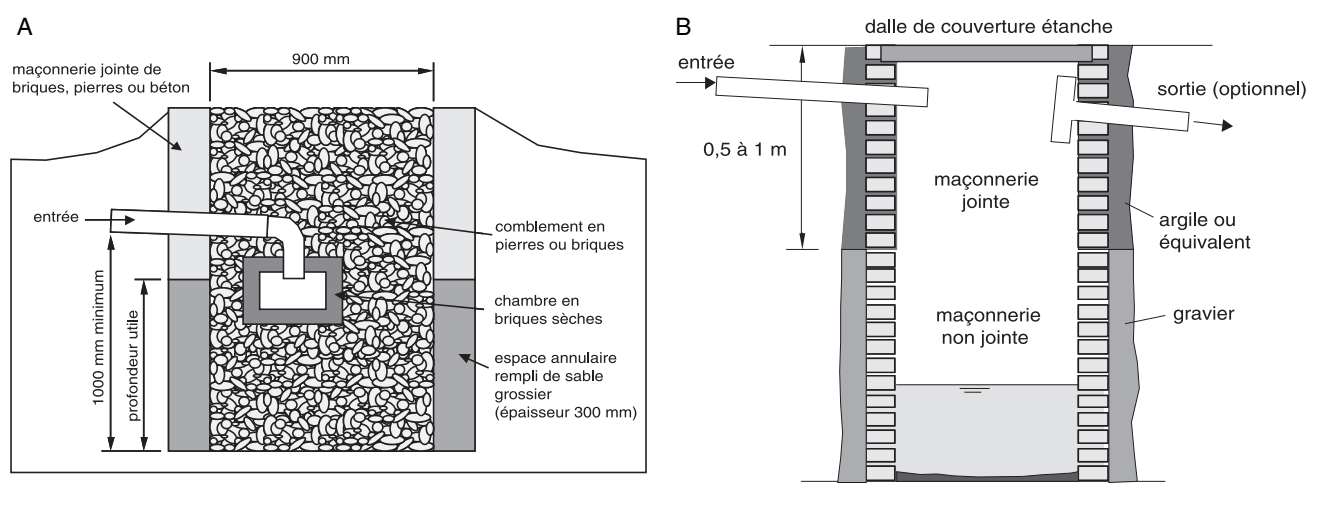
Puits perdu. A, puits sans revêtement. B, puits avec revêtement.
